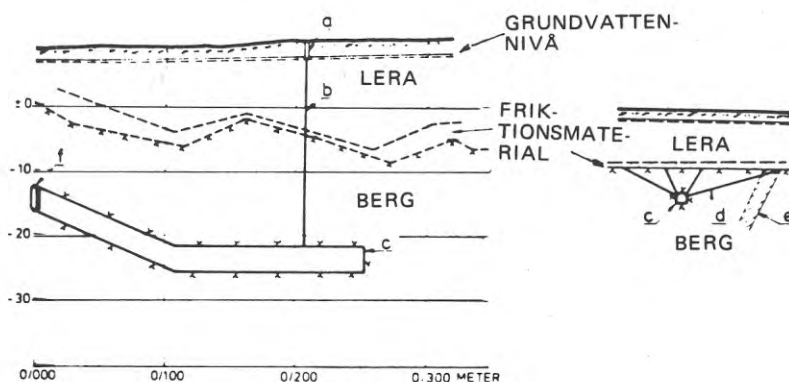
Profil och sektion genom infiltrationstunnel. Renvatten förs från påfyllningsbrunn (a) genom ett borrhål (b) till infiltrationstunneln (c). Från tunneln trycks vattnet genom borrhål (d) och infiltrerar i sprickigt berg (e) och friktionslager ovan berg. En tätvägg har utförts mellan avloppstunneln och infiltrationstunneln (f).
